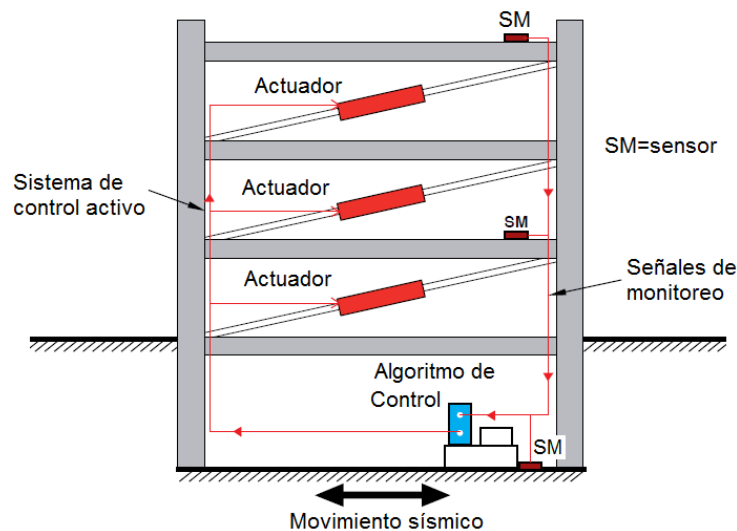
Esquema Estructurado con sistema de control activo (Cámara Chilena de la Construcción, documento técnico N°29)
